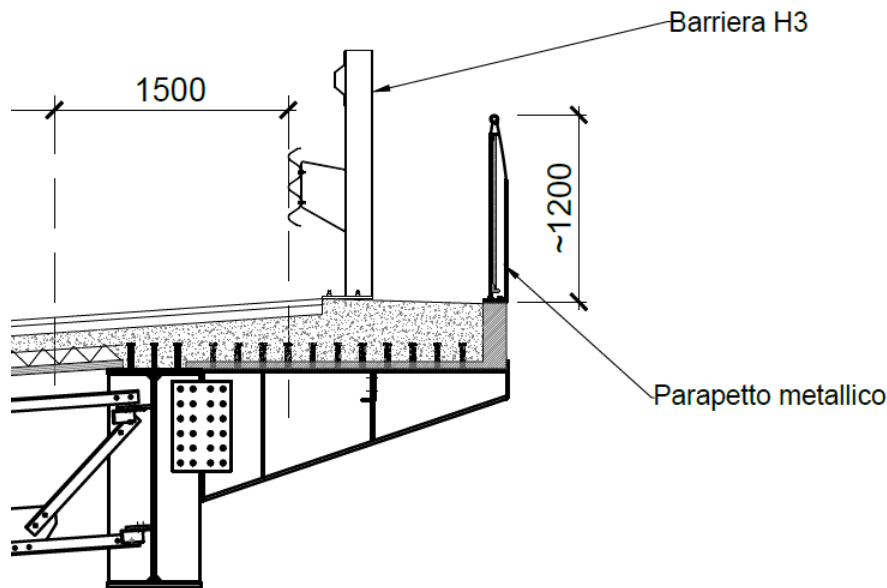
Dettaglio sezione di mezzeria del ponte con barriera di sicurezza di classe H₃ e parapetto metallico sul lato esterno.
